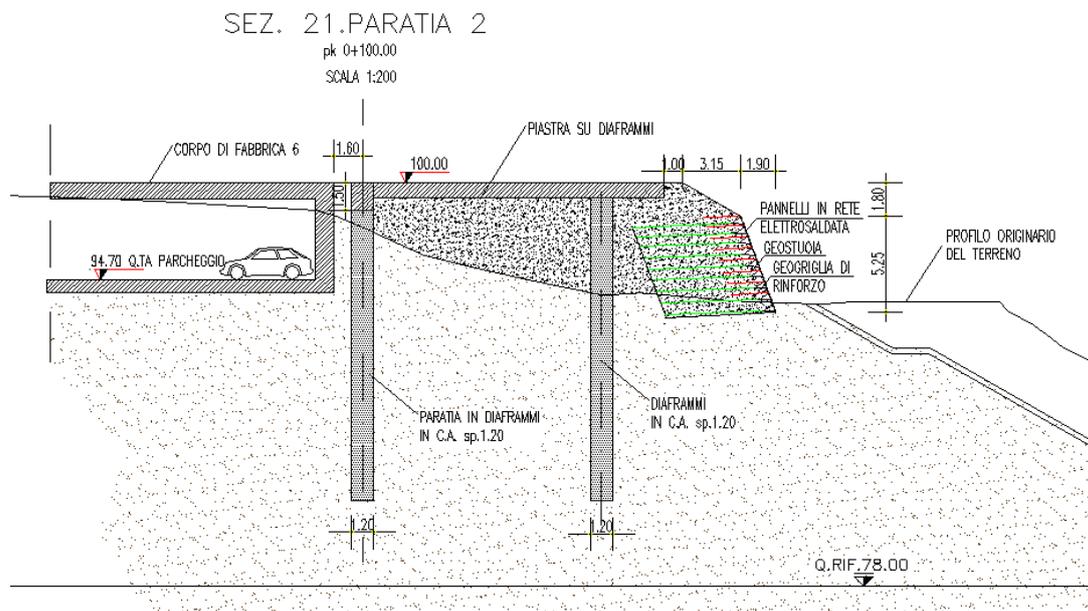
Sezione trasversale muro in TR zona Arcade
